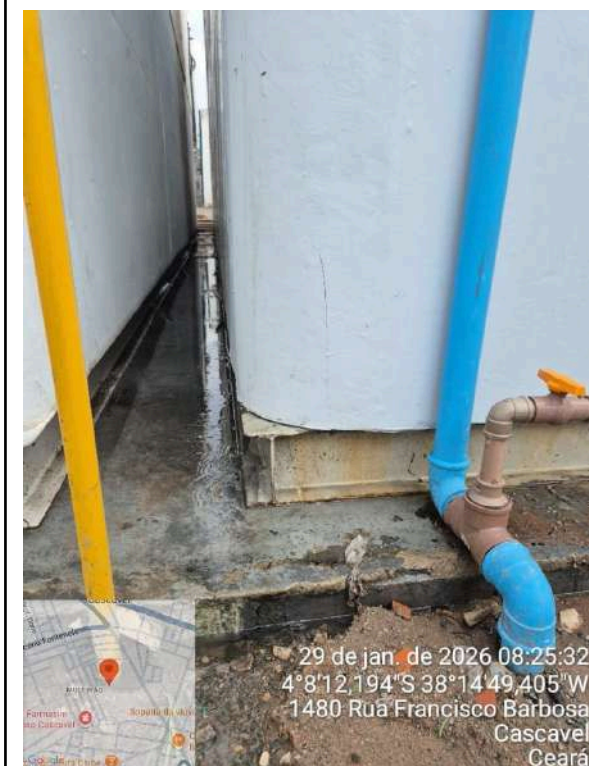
ETE Cascavel (Sede): Reatores UASB 1 e 2 com vazamento.
